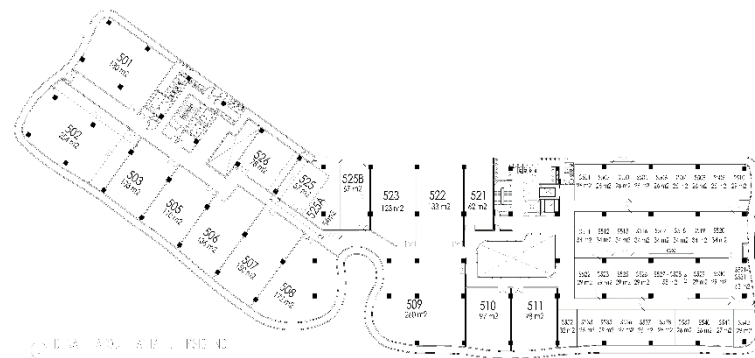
Denah Lantai 3 Spazio, (Dokumen Badan Pengelola Bangunan Spazio, 2015)
